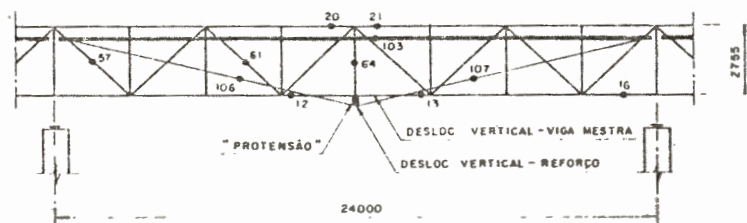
Esquema da viga mestra e pontos instrumentados (Extensômetro mecânico)
